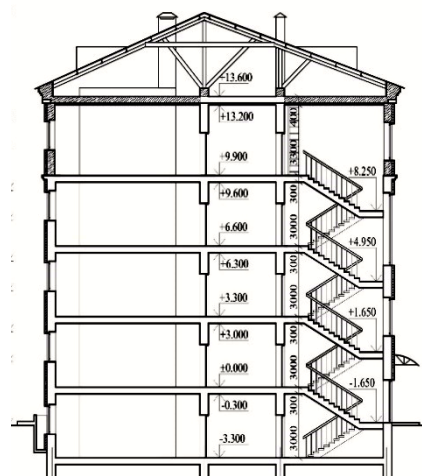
Схема реконструкції покрівлі будівлі з надбудовою поверху і влаштуванням горищного даху
